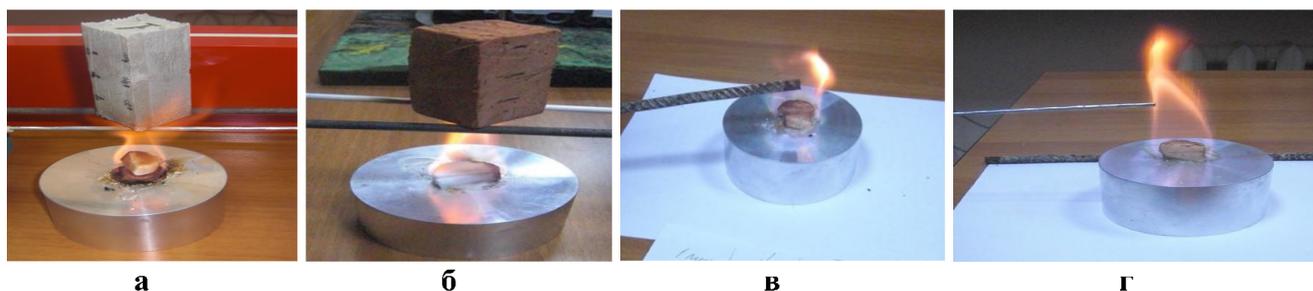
Фрагменты опытов: А-образец из железобетона, Б- образец из кирпича, В-образец из стальной арматуры, Г- образец из круглой стали
